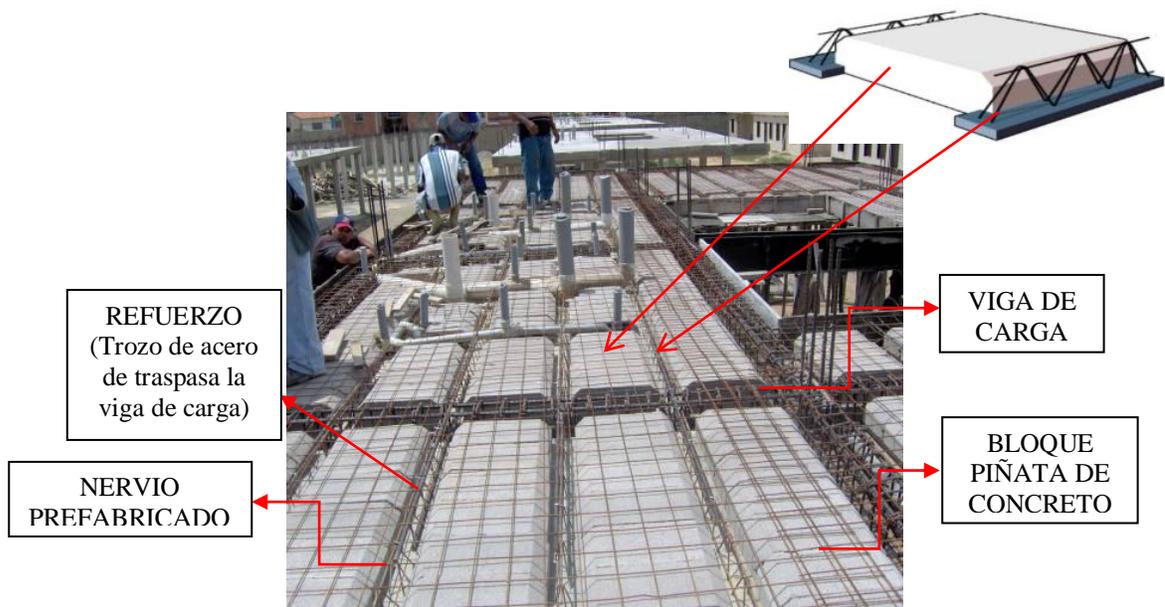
Planta de envigado de entrepiso. Losa nervada en una dirección. Con nervios prefabricados (Town Houses). *Nota.* Bonucci (2012).
